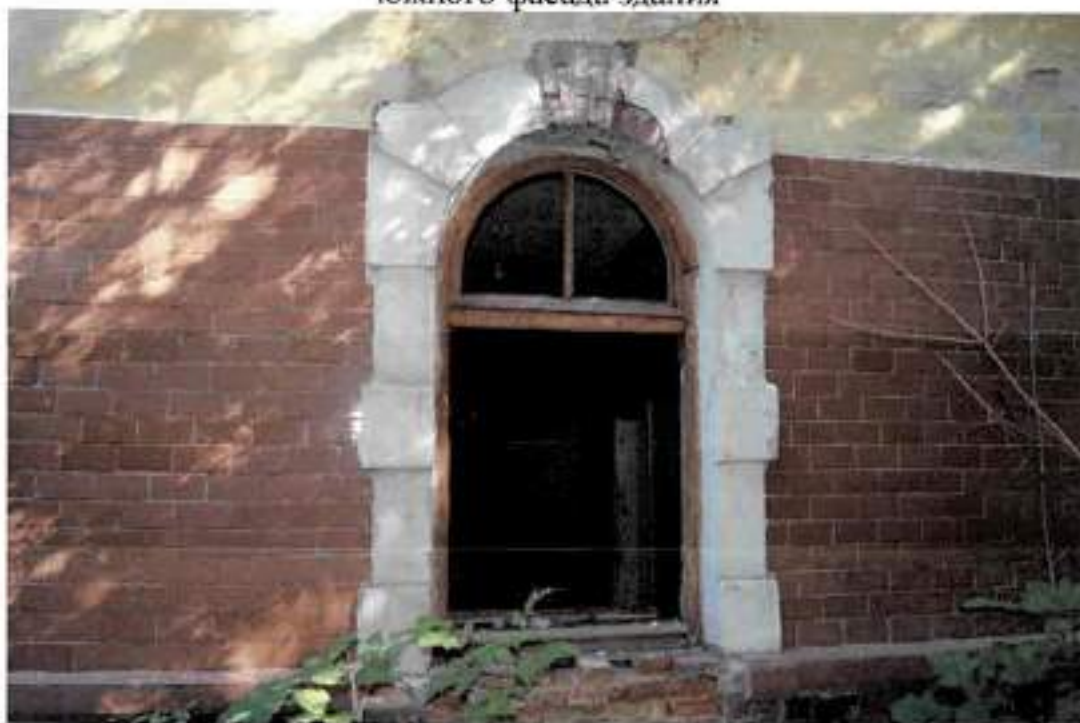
Вид на арочный оконный проем на 1-м этаже южного фасада здания
